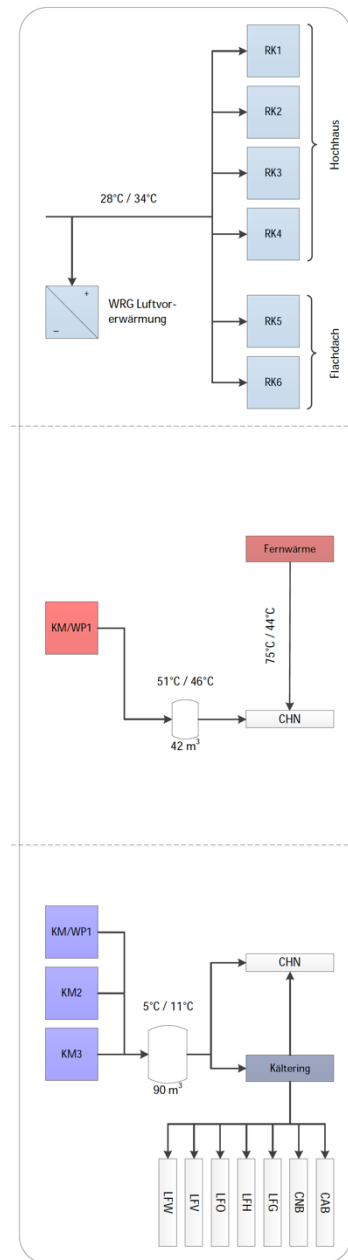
Ablöseplan Kälteversorgung nach Bauetappe 4
